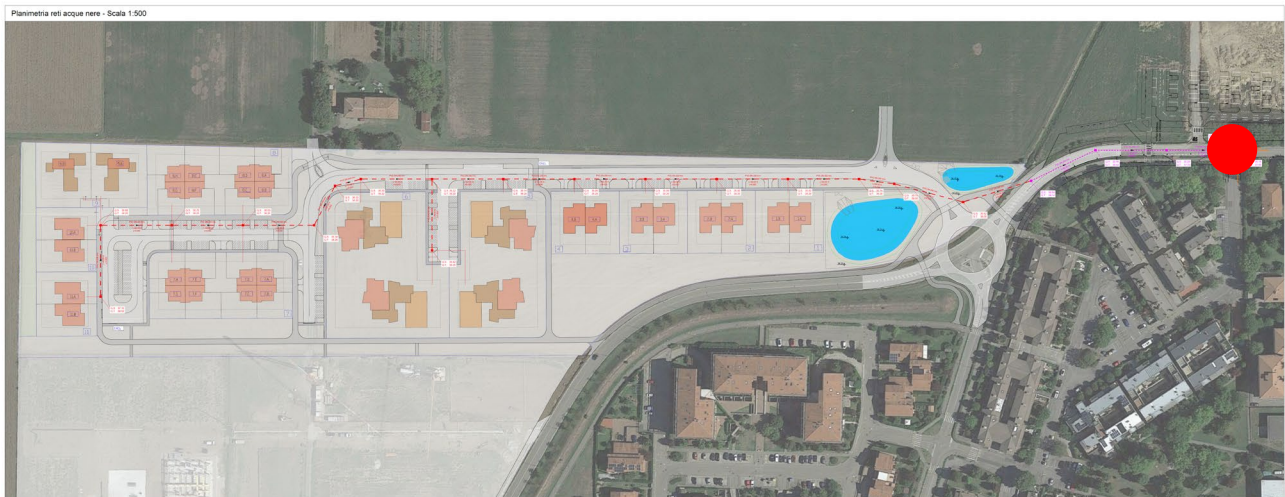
Estratto elaborato C.8 - Schemi reti fognature - Planimetria acque nere
